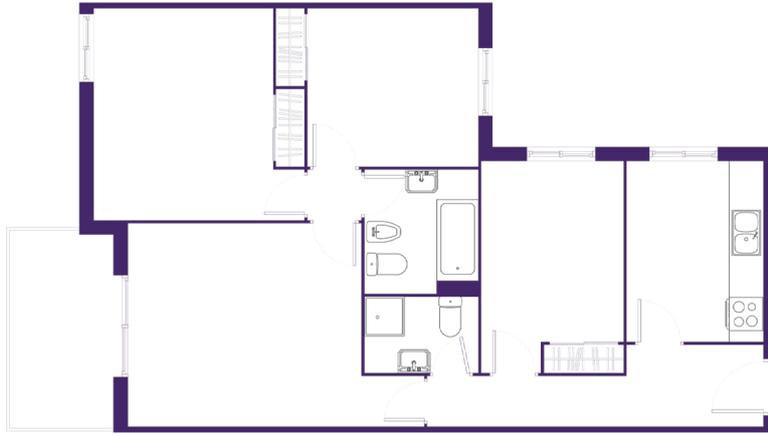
Vivienda de Pilar. Modificaciones sobre la original.
